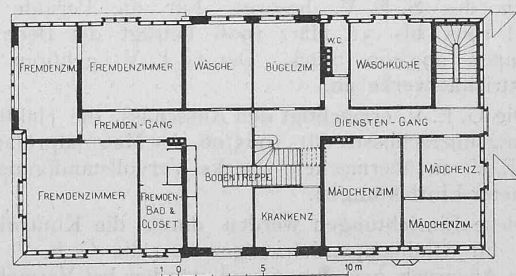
Grundriss vom Dachgeschoss. — Masstab 1 : 400.
